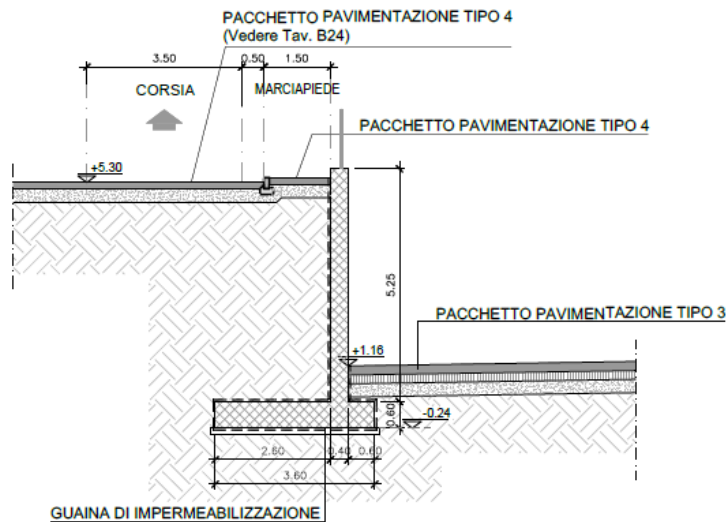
Sezioni del muro di sostegno della rampa di accesso
